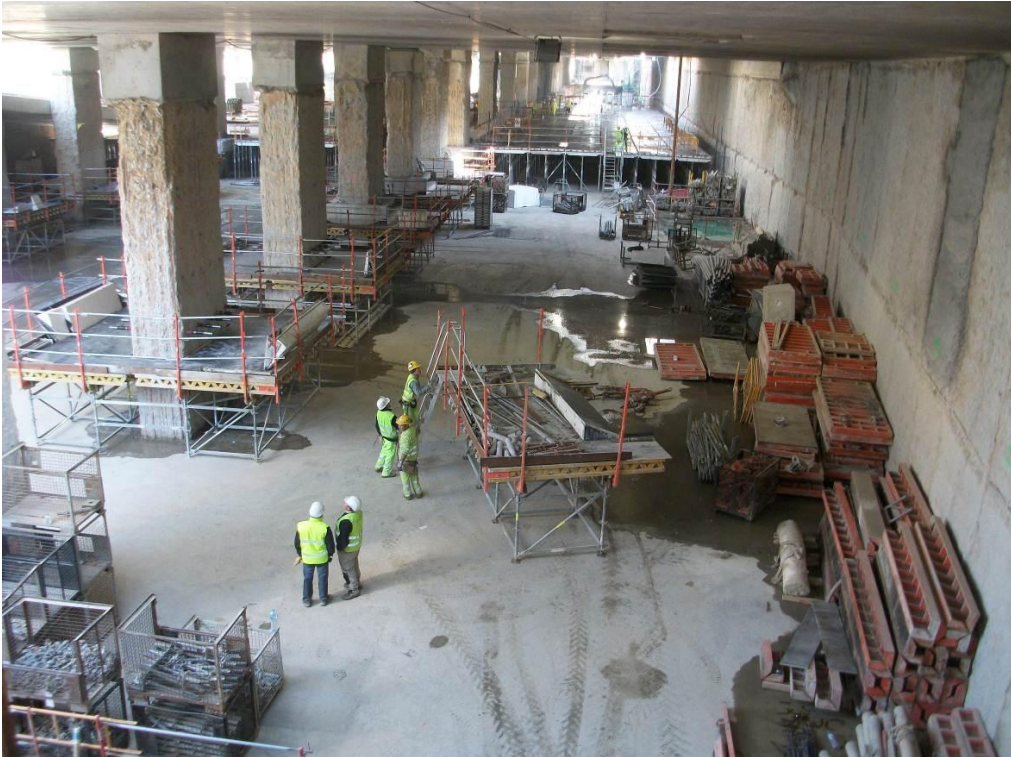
Vista del túnel central con la tuneladora al fondo arrastrándose por la cuna en construcción justo por delante de ésta.
